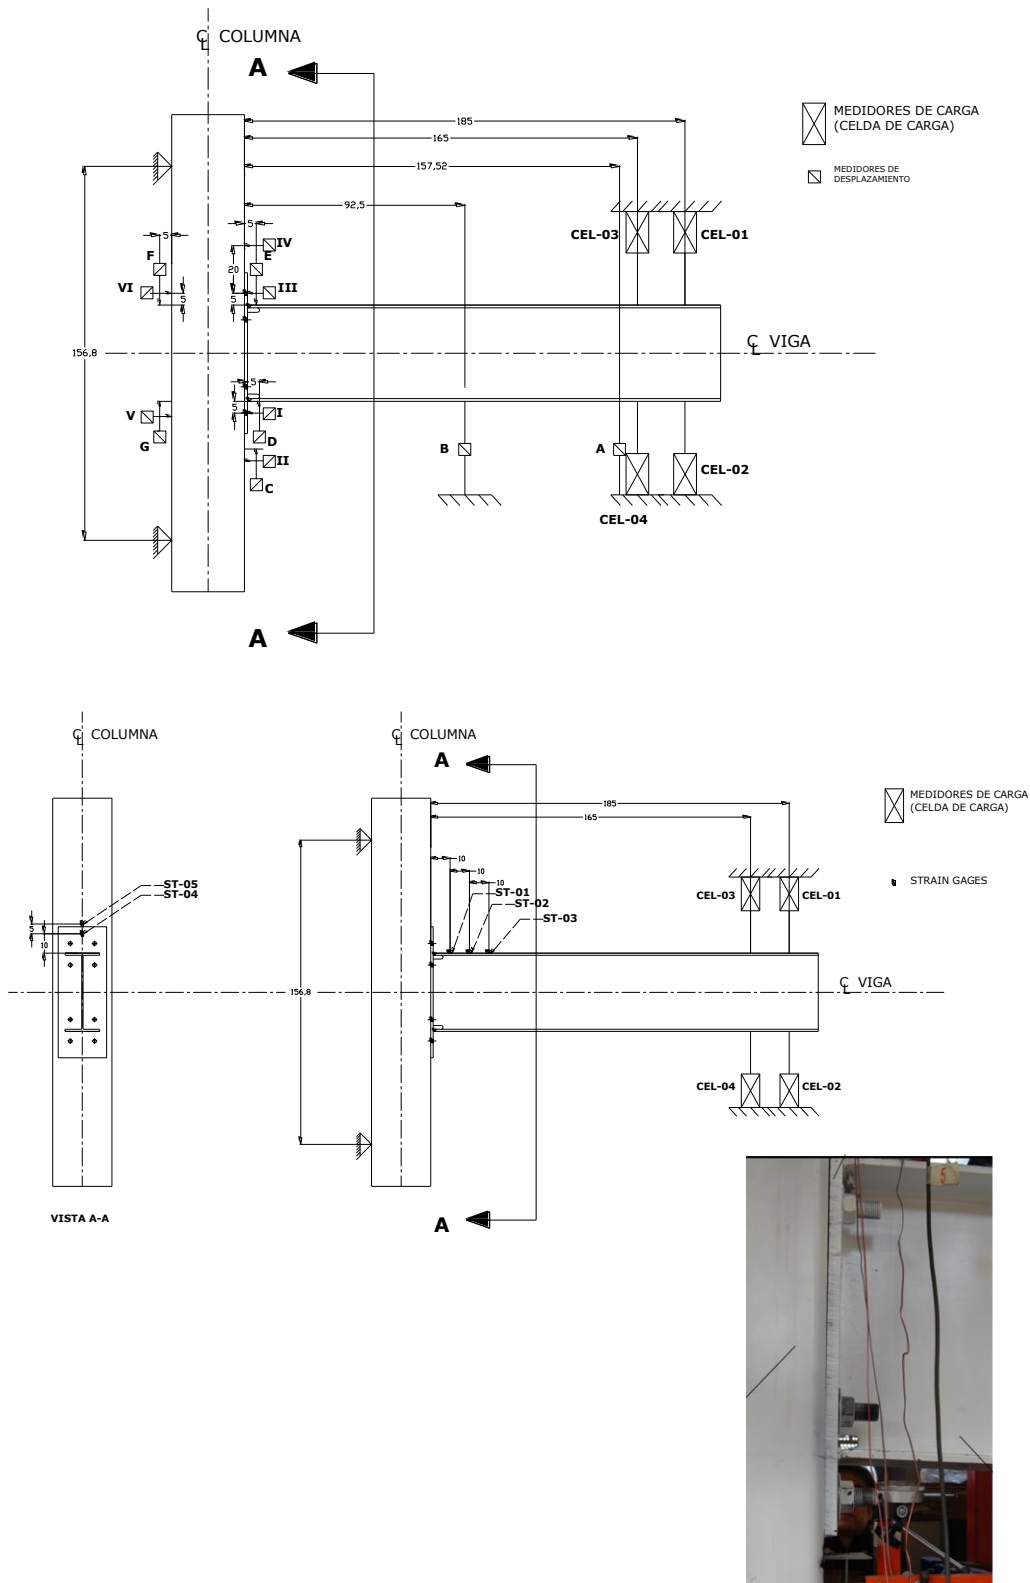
Instrumentación del espécimen ECA4. Deformímetros (arriba) y straingages (abajo)
